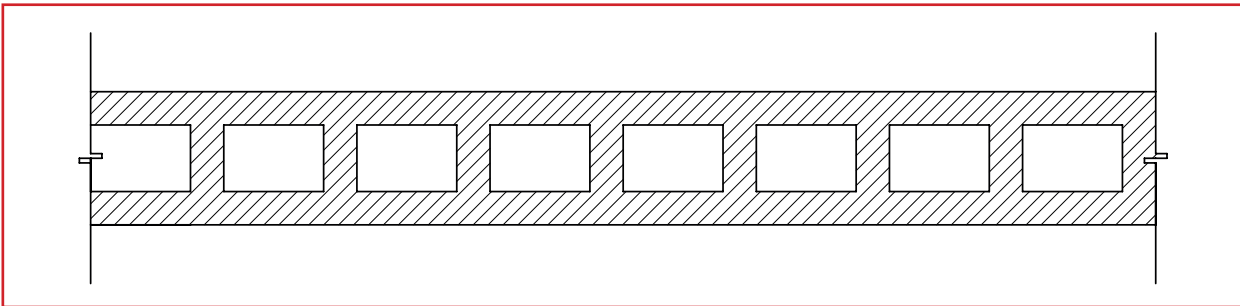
Tubería de pared estructurada de perfil cerrado
